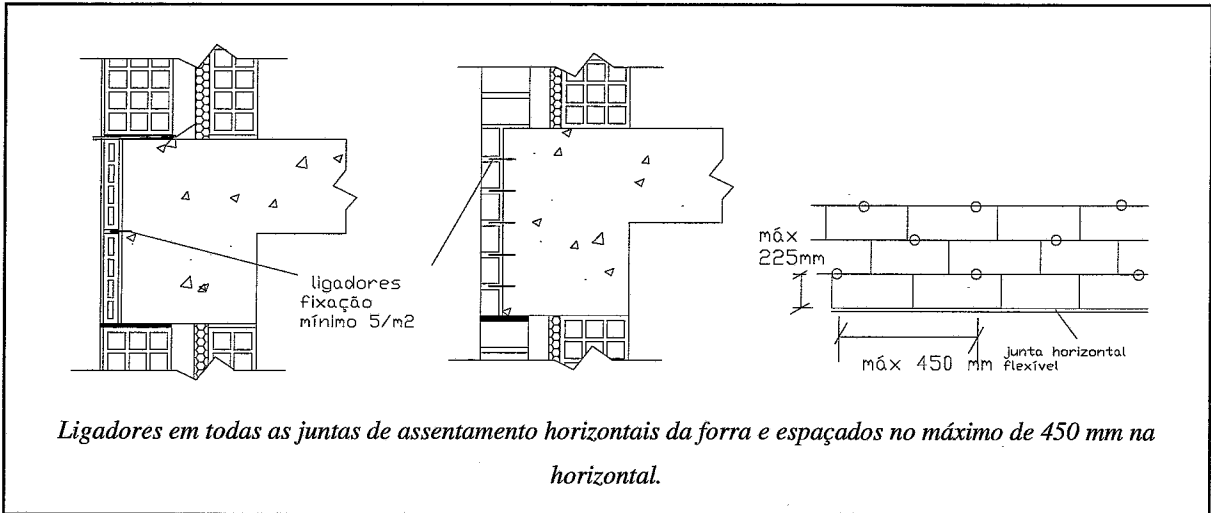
Pormenor da fixação da forra cerâmica exterior em zona de viga com a colocação de grampos nas juntas horizontais
